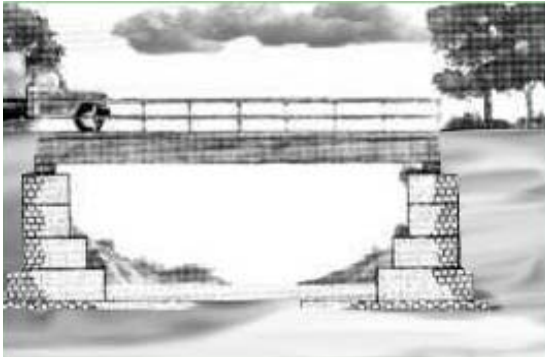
Puente de vigas simplemente apoyadas (isostático) un tramo.
